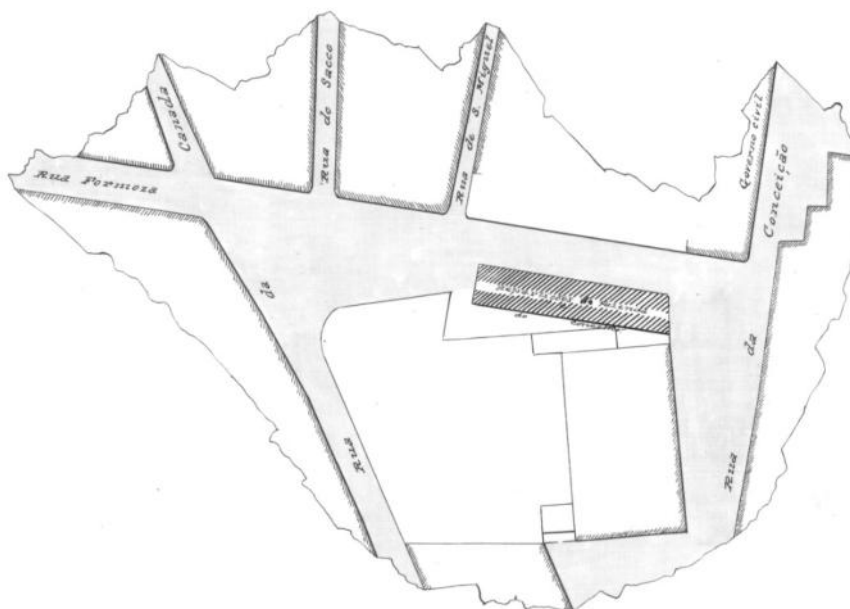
Detalhe da planta de localização na planta de 1900 (ca) com a Rua formosa concluída (Anexo 10)⁵⁰⁷
